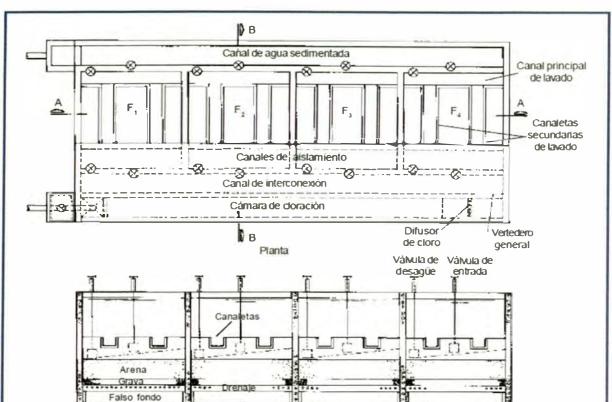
Batería de filtros de lavado mutuo y tasa declinante.
